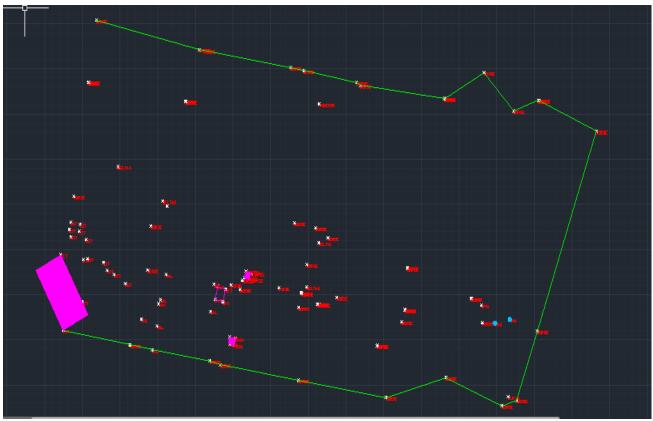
Plano Inicial AUTOCAD- Fuente propia
